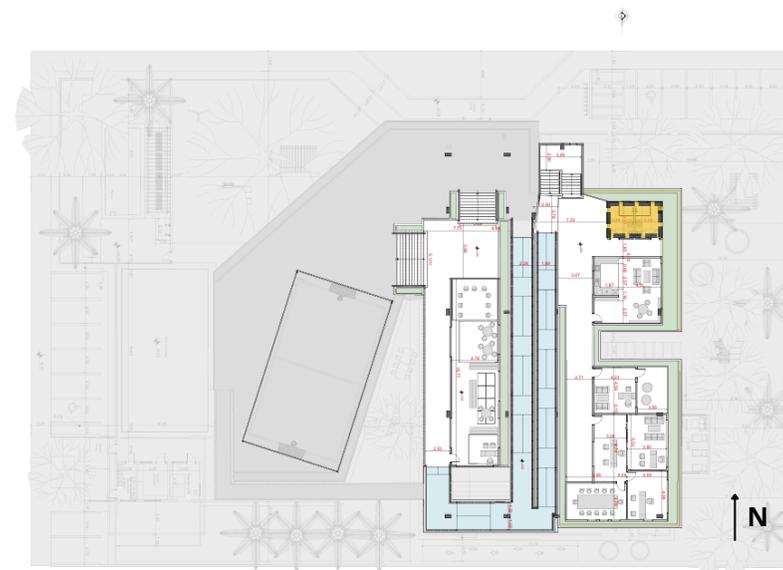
Planta baixa Pavimento Mezanino 2 e Térreo +2
